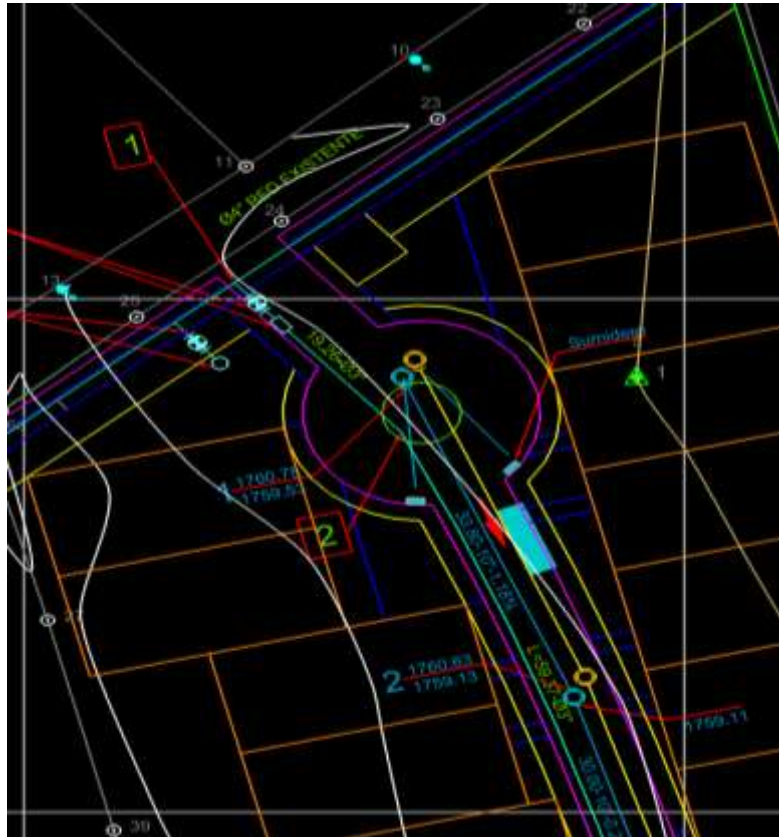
Plano en planta de red hidráulica y sanitaria
